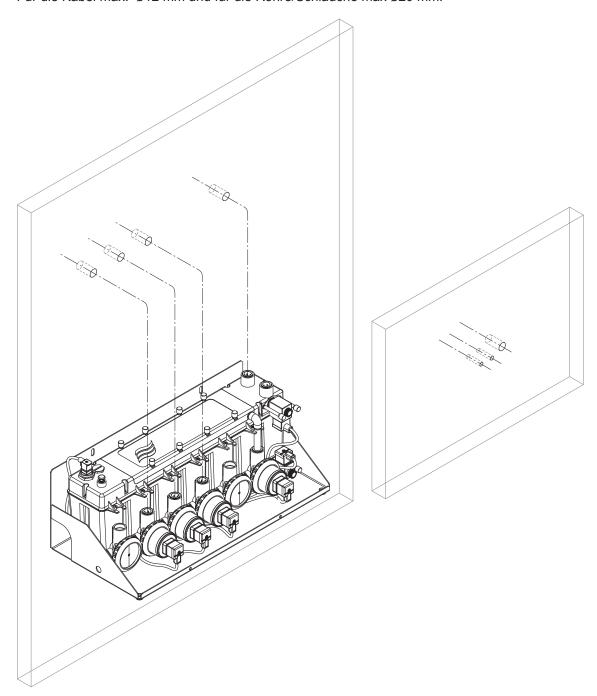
Durchführungsbohrungen bohren (Aussenmontage)
